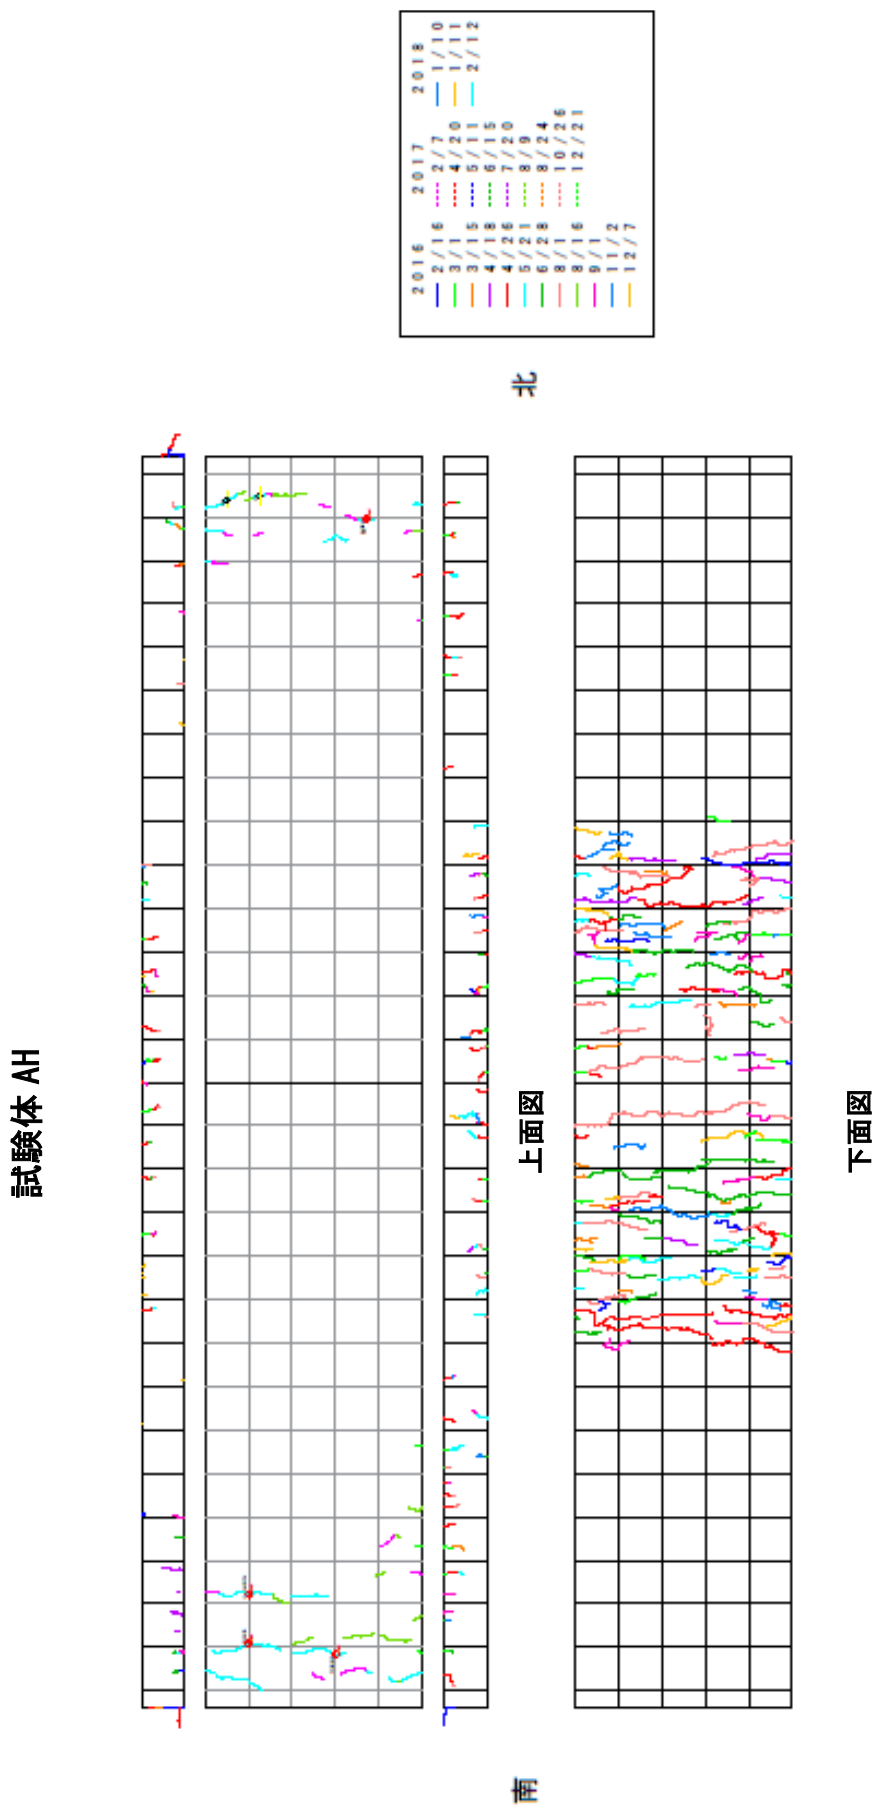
試験体 AH ひび割れ図
